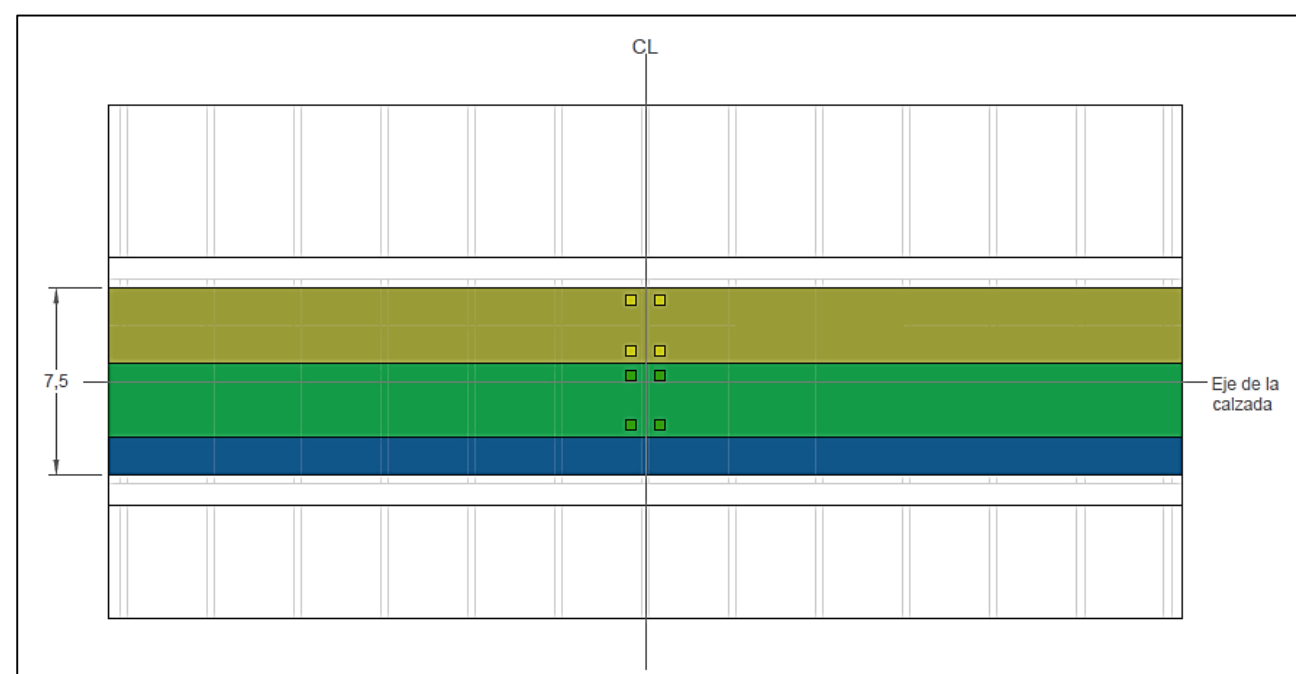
Caso 1 de sobrecargas de uso - Planta. Elaboración propia con AutoCAD
